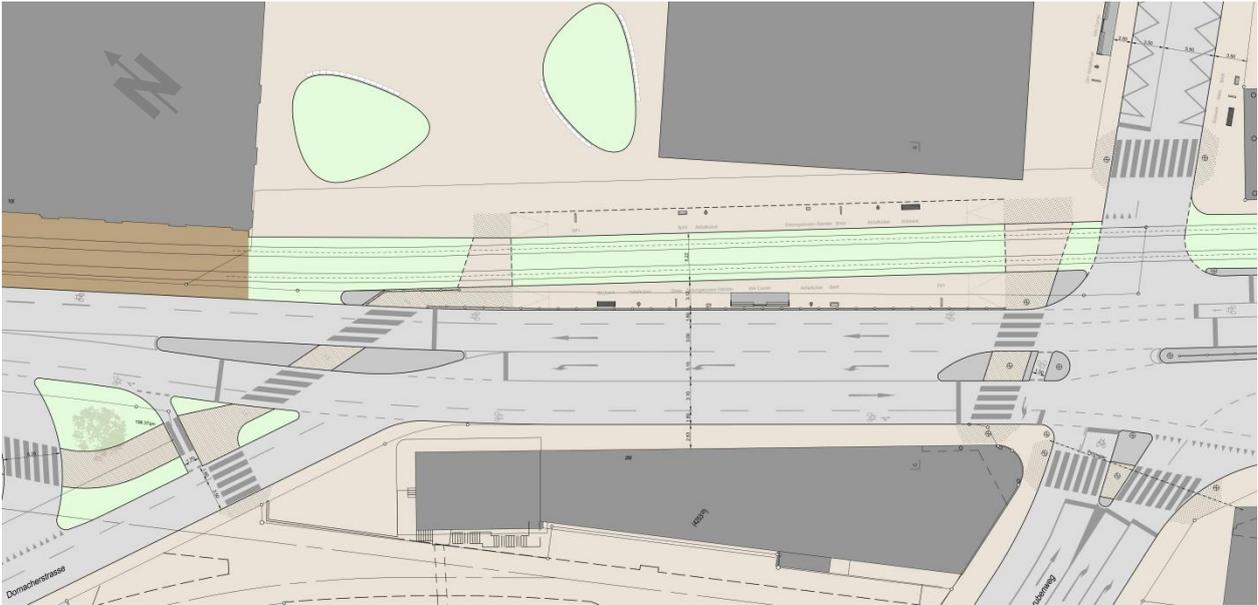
Projekt im Abschnitt C: Walkeweg bis Dornacherstrasse
